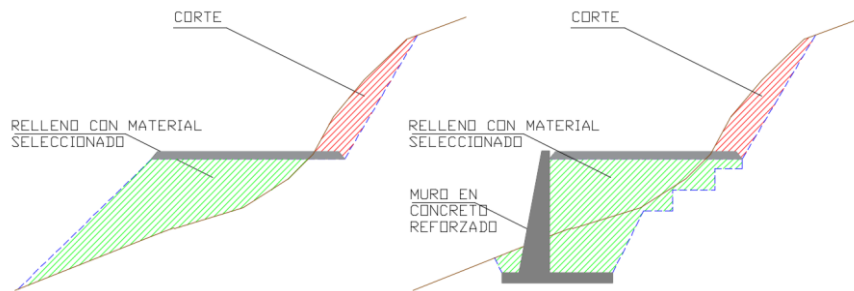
Sección ilustrativa funcionamiento de los muros de confinamiento en concreto reforzado
